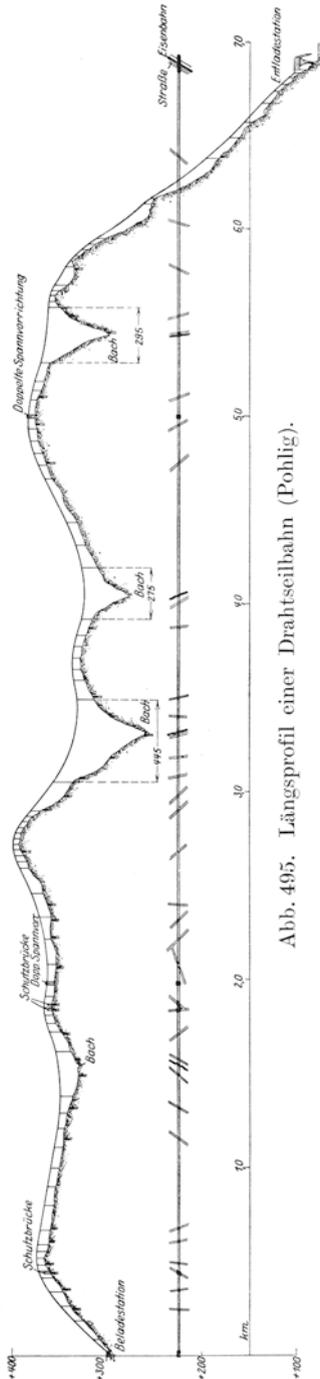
Längsprofil einer Drahtseilbahn (Pohlig).
